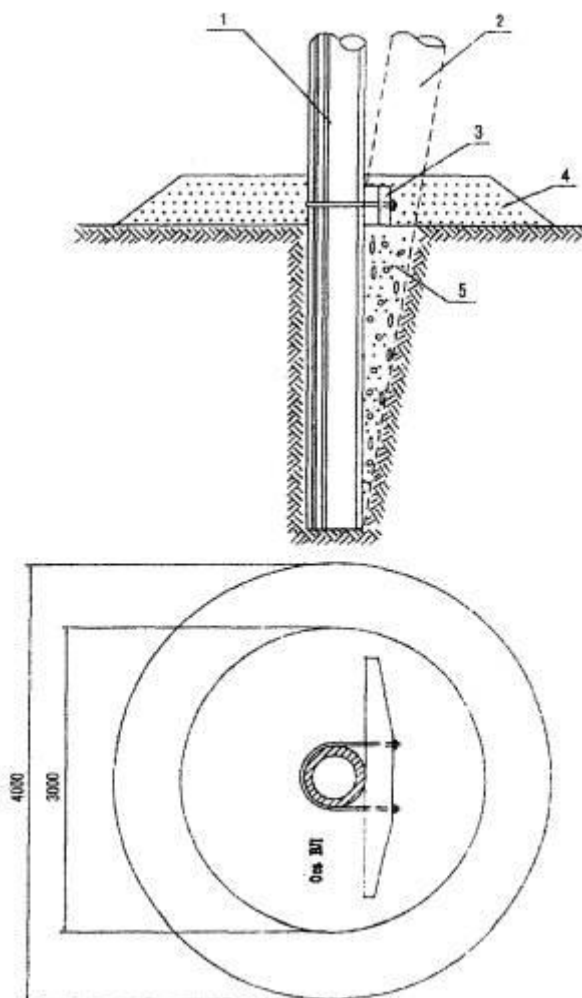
Усиление заделки железобетонной опоры банкеткой с ригелем:
